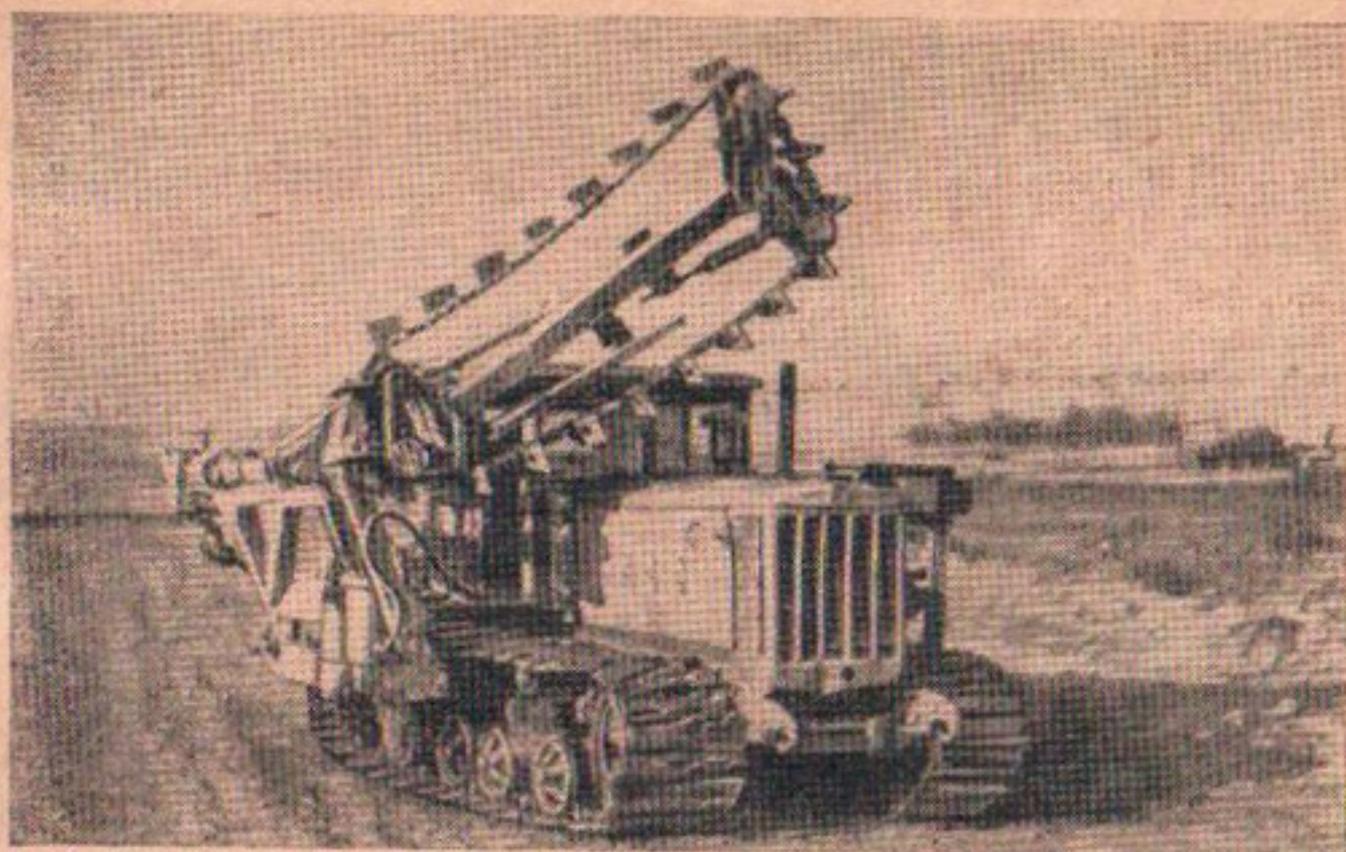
Общий вид каналоочистителя Д-490М со скребковой цепью.
